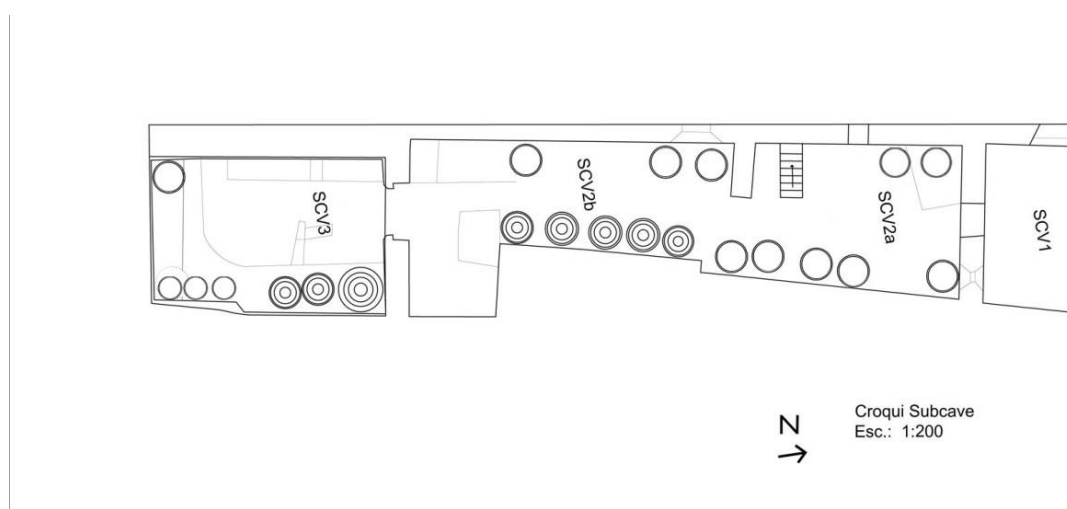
Croqui subcave: Casa das Talhas – Esc.: 1:200
